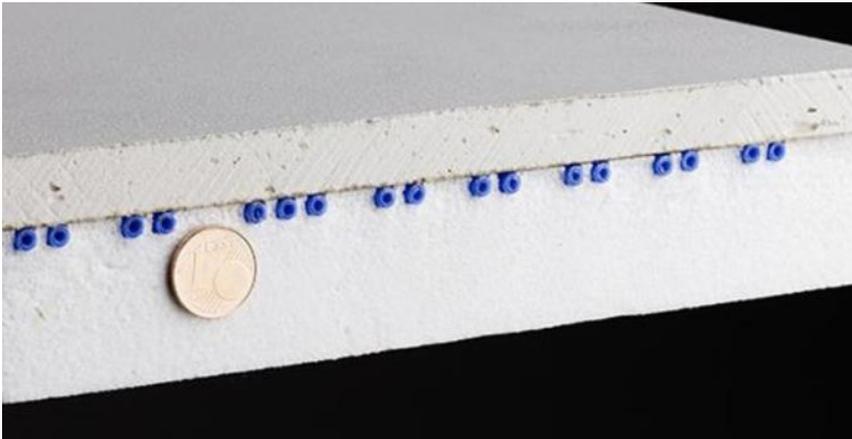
Trockenbauelement mit Kapillarrohrmatte zum Nachrüsten einer Deckenheizung (Beka Klima, o. J.)
